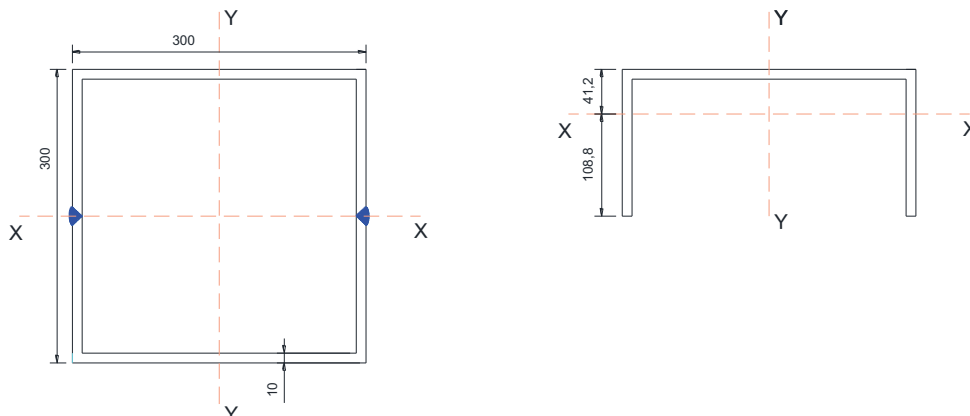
Detalle de soldadura en la columna armada
